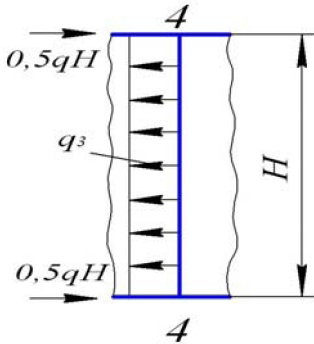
Схема передачи местной нагрузки со стойки на пояса
